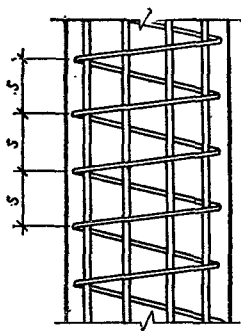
Схема армирования колонн поперечной арматурой в виде спирали.
